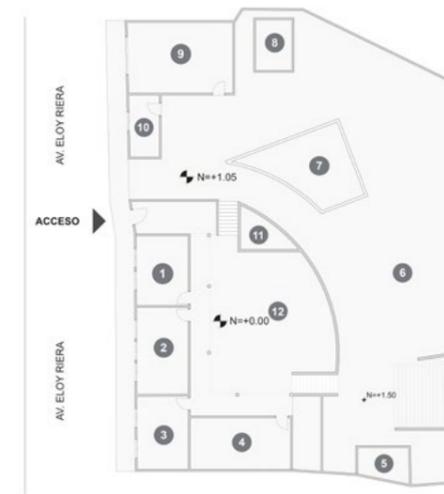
Planta Baja de la Escuela Checa. Fuente: Elaboración propia, 2025.
